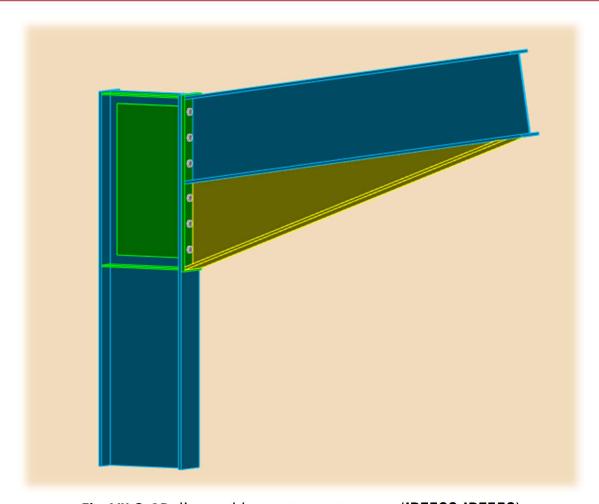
3D d'assemblage poteau - traverse (IPE500-IPE550)
